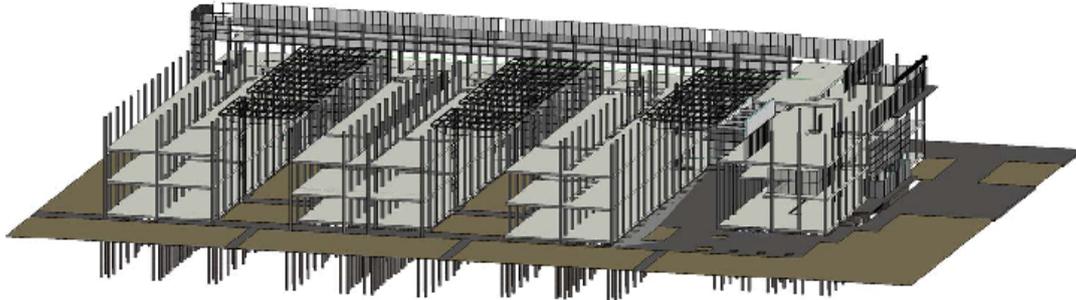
Modelo 3D Estructura. 2014. Fuente propia.
